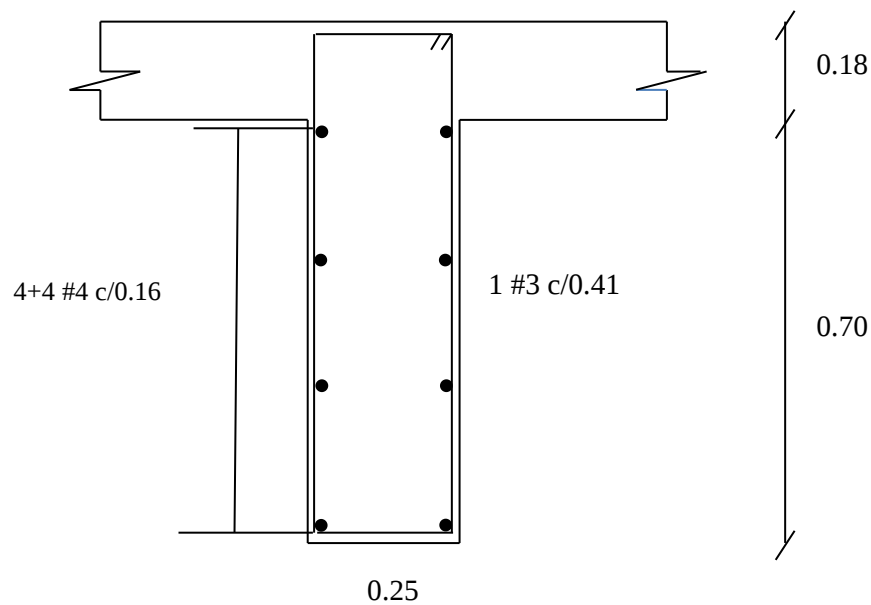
Detalle de armado de la viga diafragma, vista transversal.
